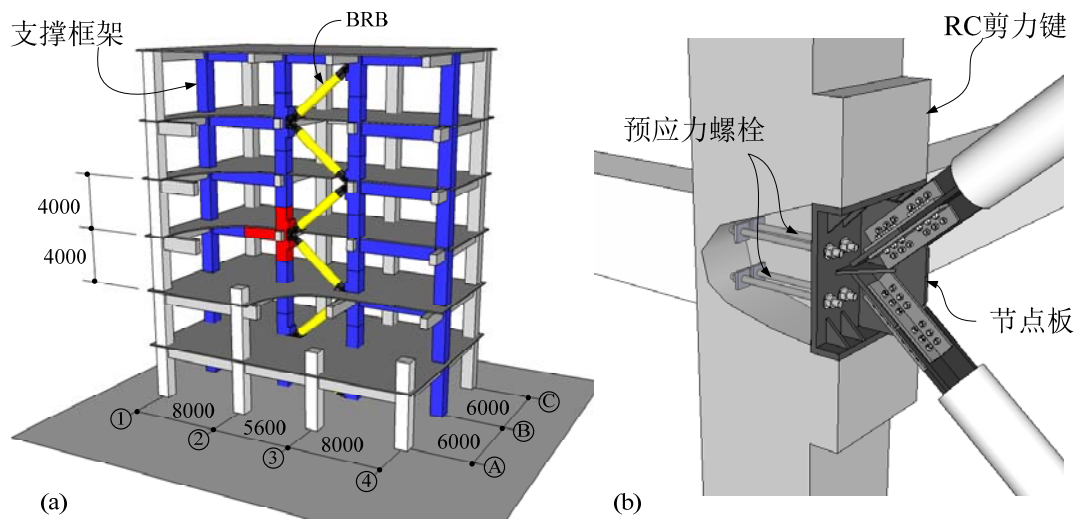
连续 Z 字形布置防屈曲支撑的钢筋混凝土框架结构示意图: (a) 结构体系; (b) 连接构造
